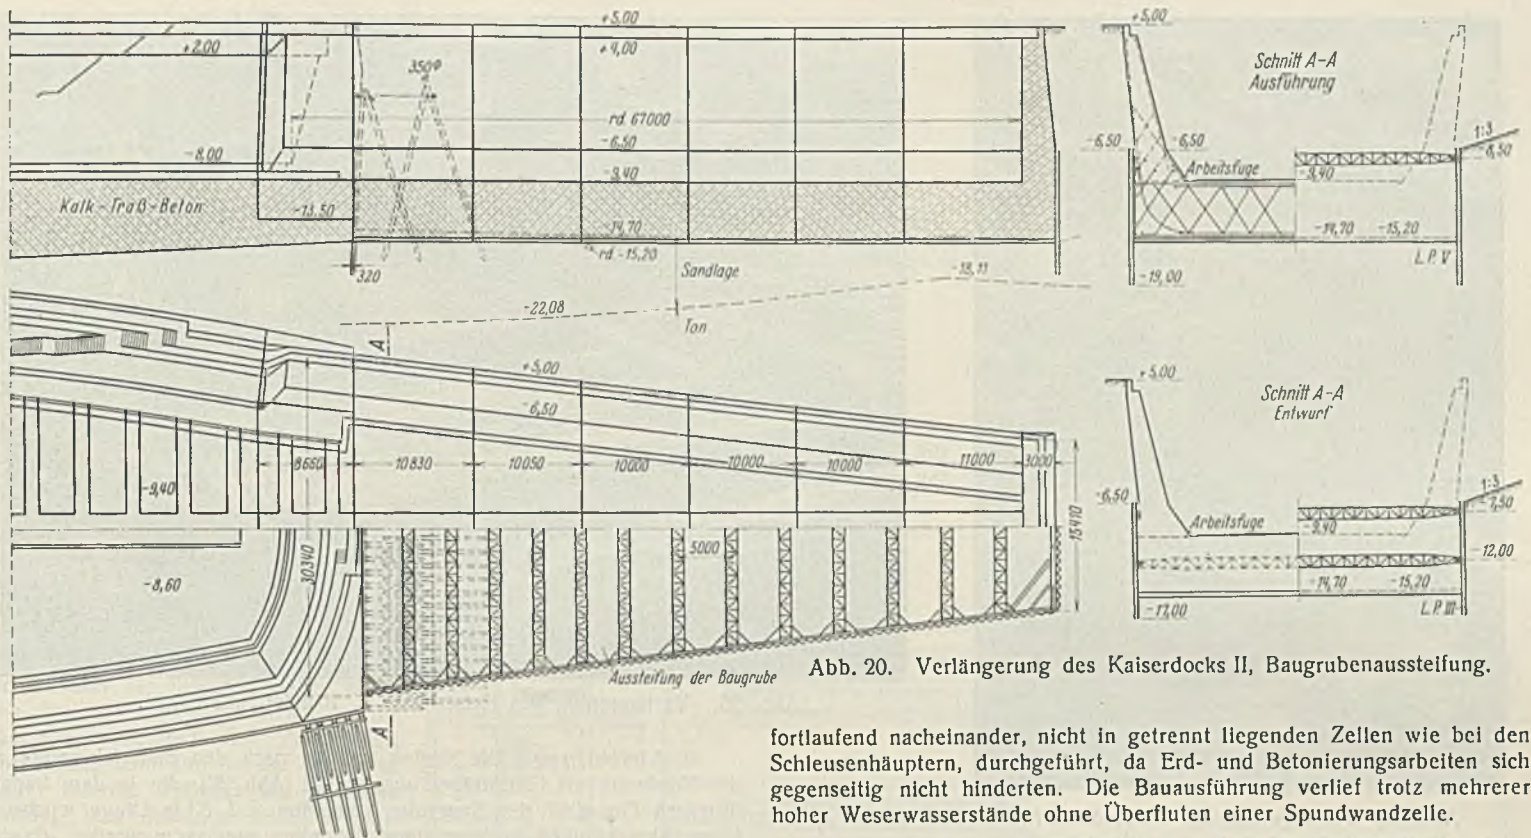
Verlängerung des Kaiserdocks II, Baugrubenaussteifung.
